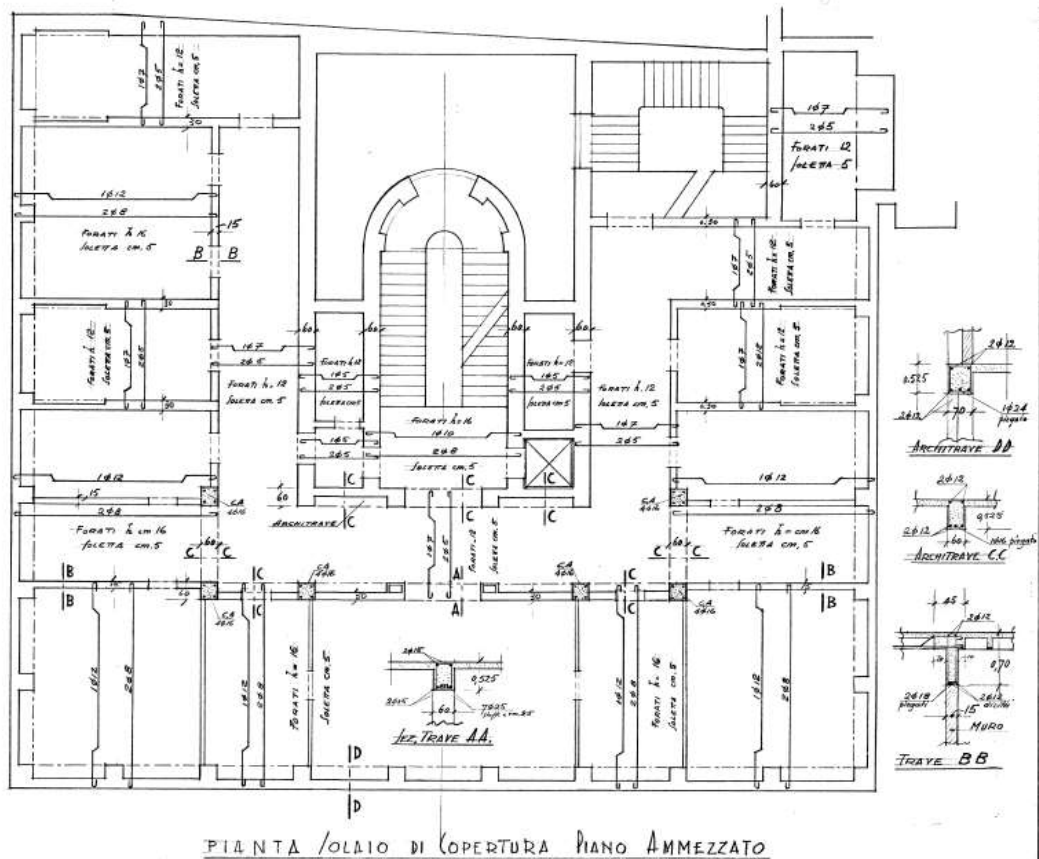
Pianta solaio di copertura piano primo (da progetto preliminare), con indicazione delle travi in c.a.
